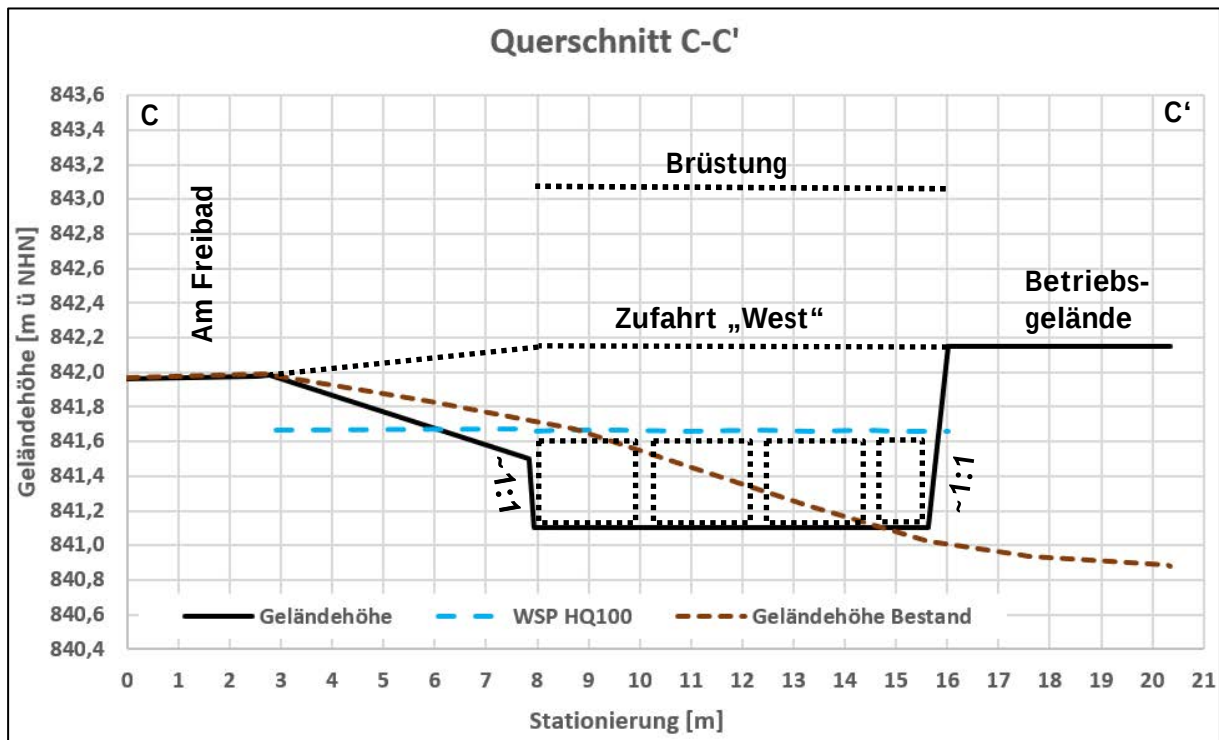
Querschnitt C-C' vor Zufahrt „West“; Gelände Planung; Wasserspiegellage HQ₁₀₀; Gelände Bestand; skizzierte Rechteckdurchlässe in Zufahrt „West“; skizzierte Fahrbahn der Zufahrt „West“; skizzierte Brüstung (1m über Fahrbahn)
